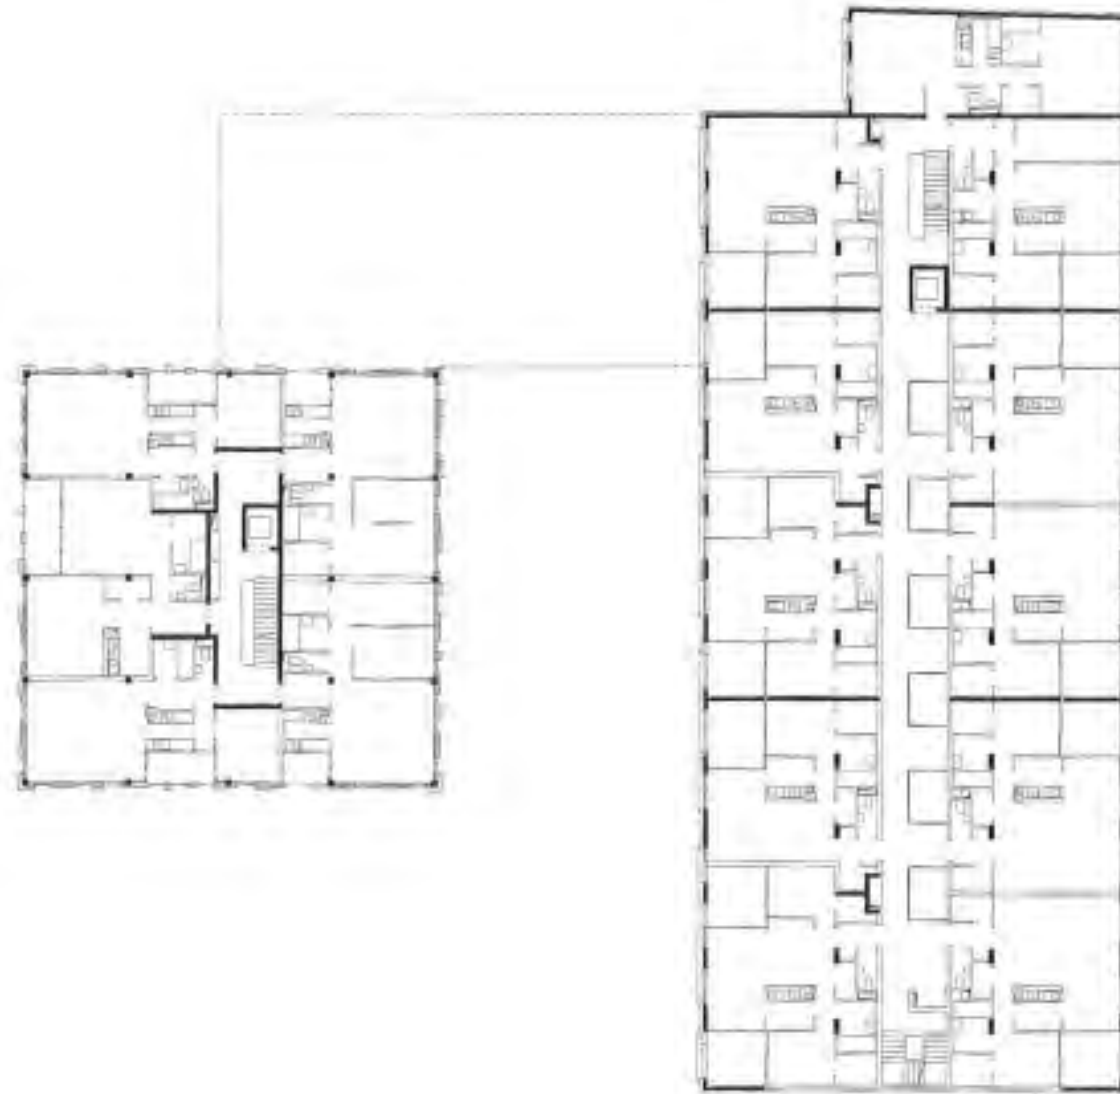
Grundriss Regelgeschoß; Arge Elsa Prochazka und Baumschlagler Eberle PARC ZT
